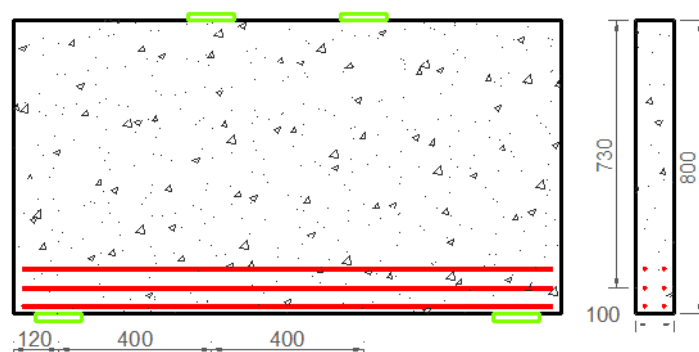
Viga A2 – dimensões em milímetros (mm) – adaptado de Guimarães (1980).
